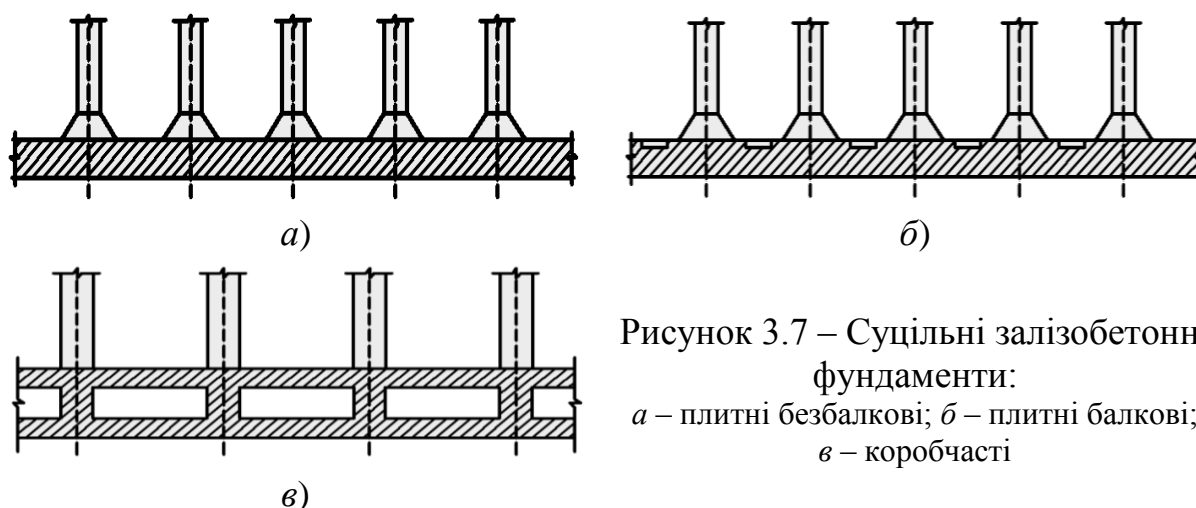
Суцільні залізобетонні фундаменти:
